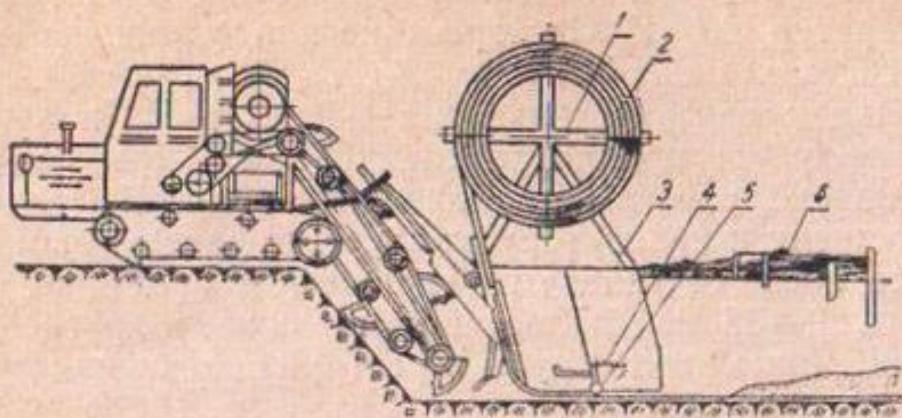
Схема установки дополнительного оборудования на экскаватор ЭТН-171 при строительстве пластмассового дренажа из готовых труб:
